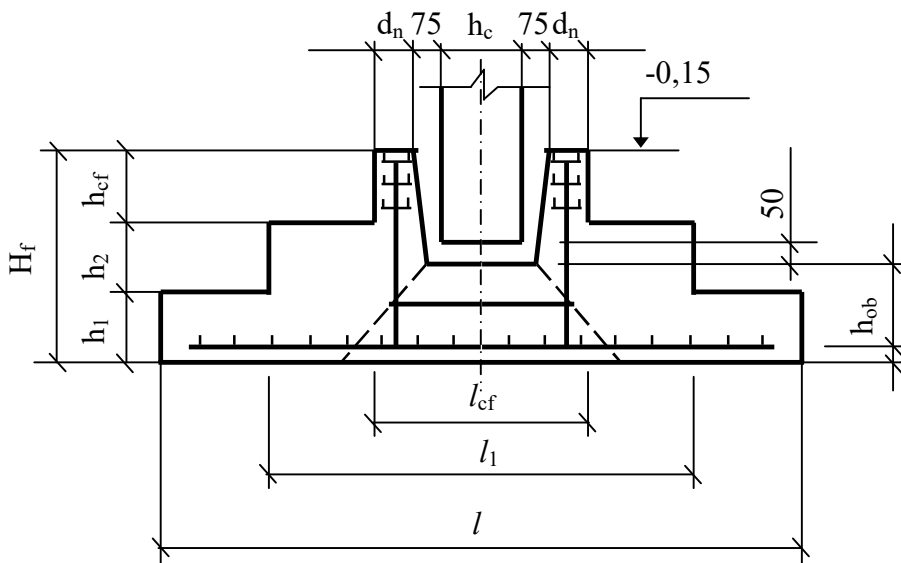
Конструкція фундаменту під збірну колону без підколонника
